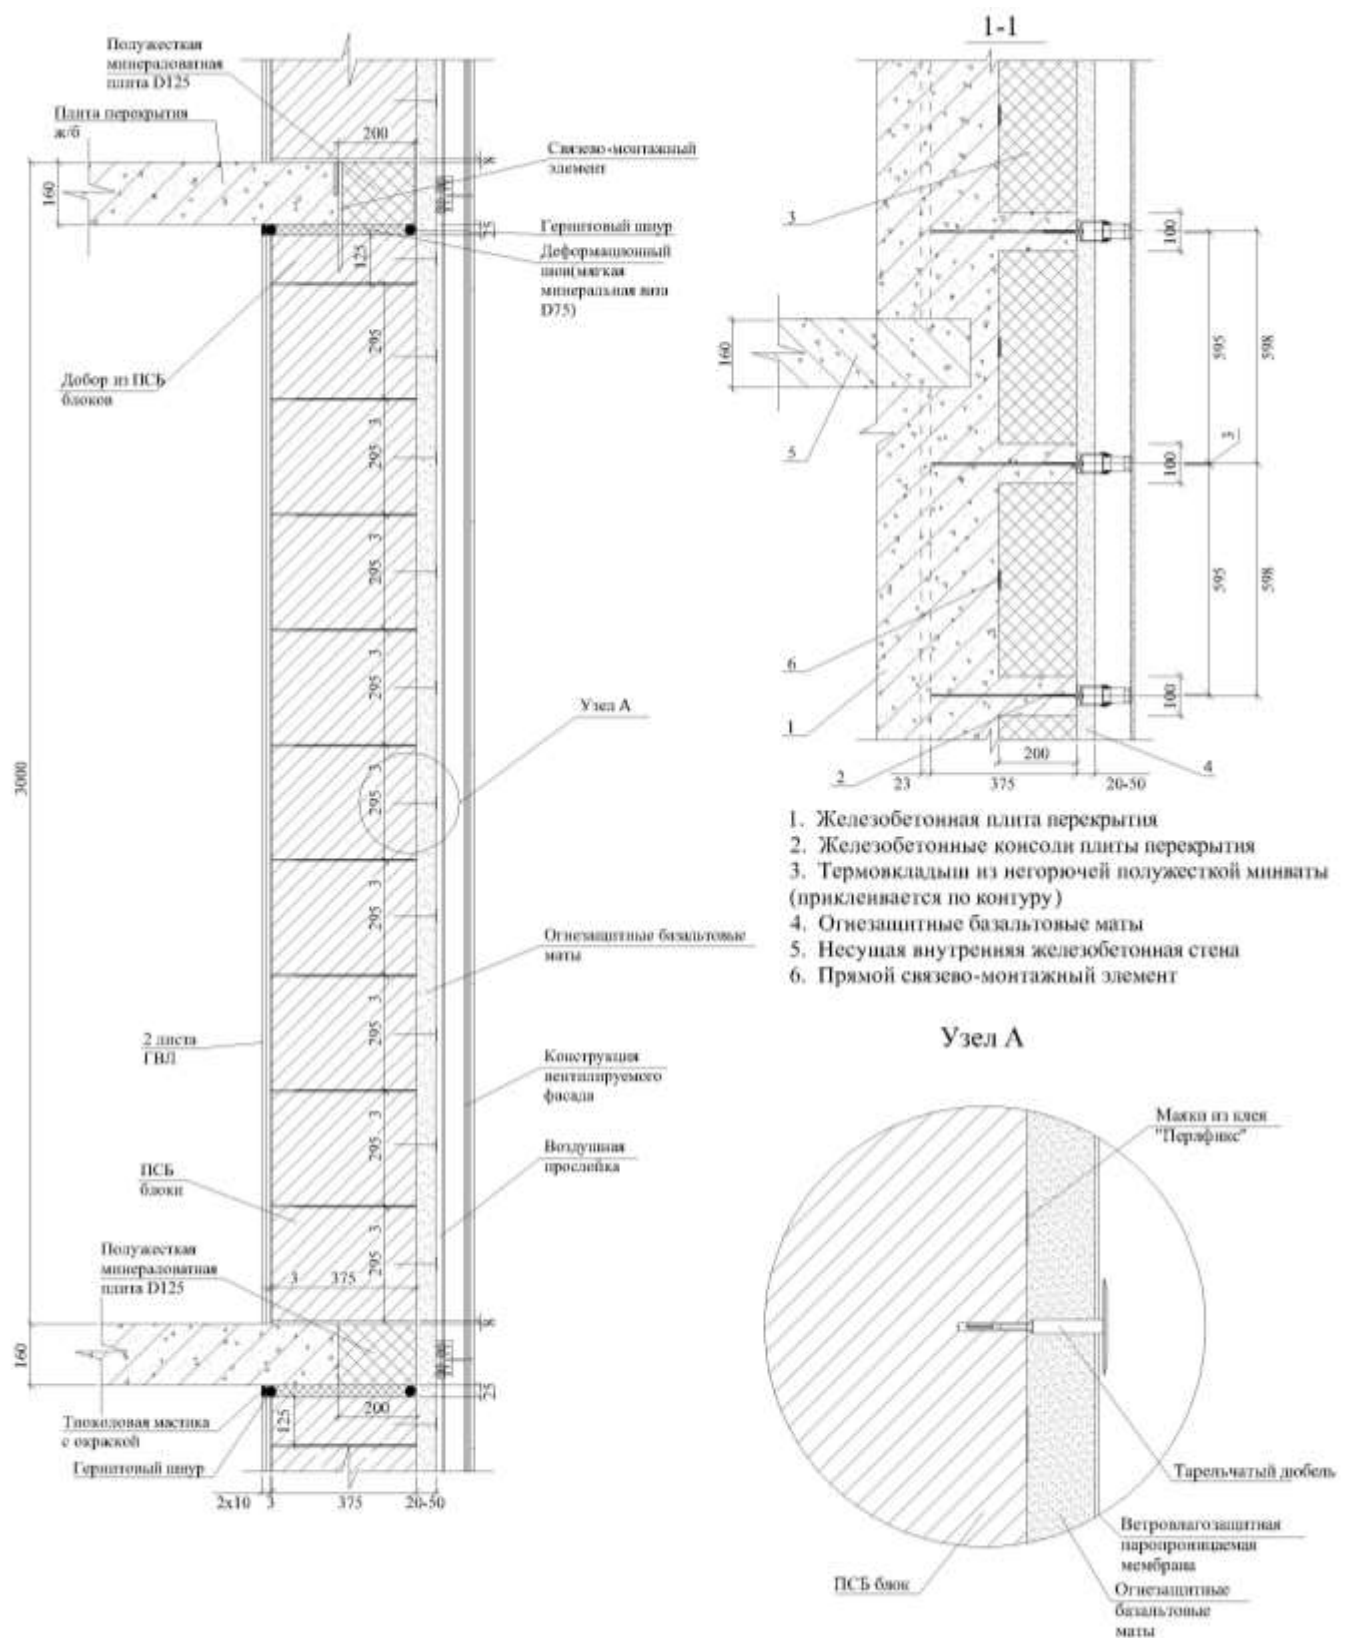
Вертикальный разрез по глухому простенку и горизонтальный разрез по перекрытию
